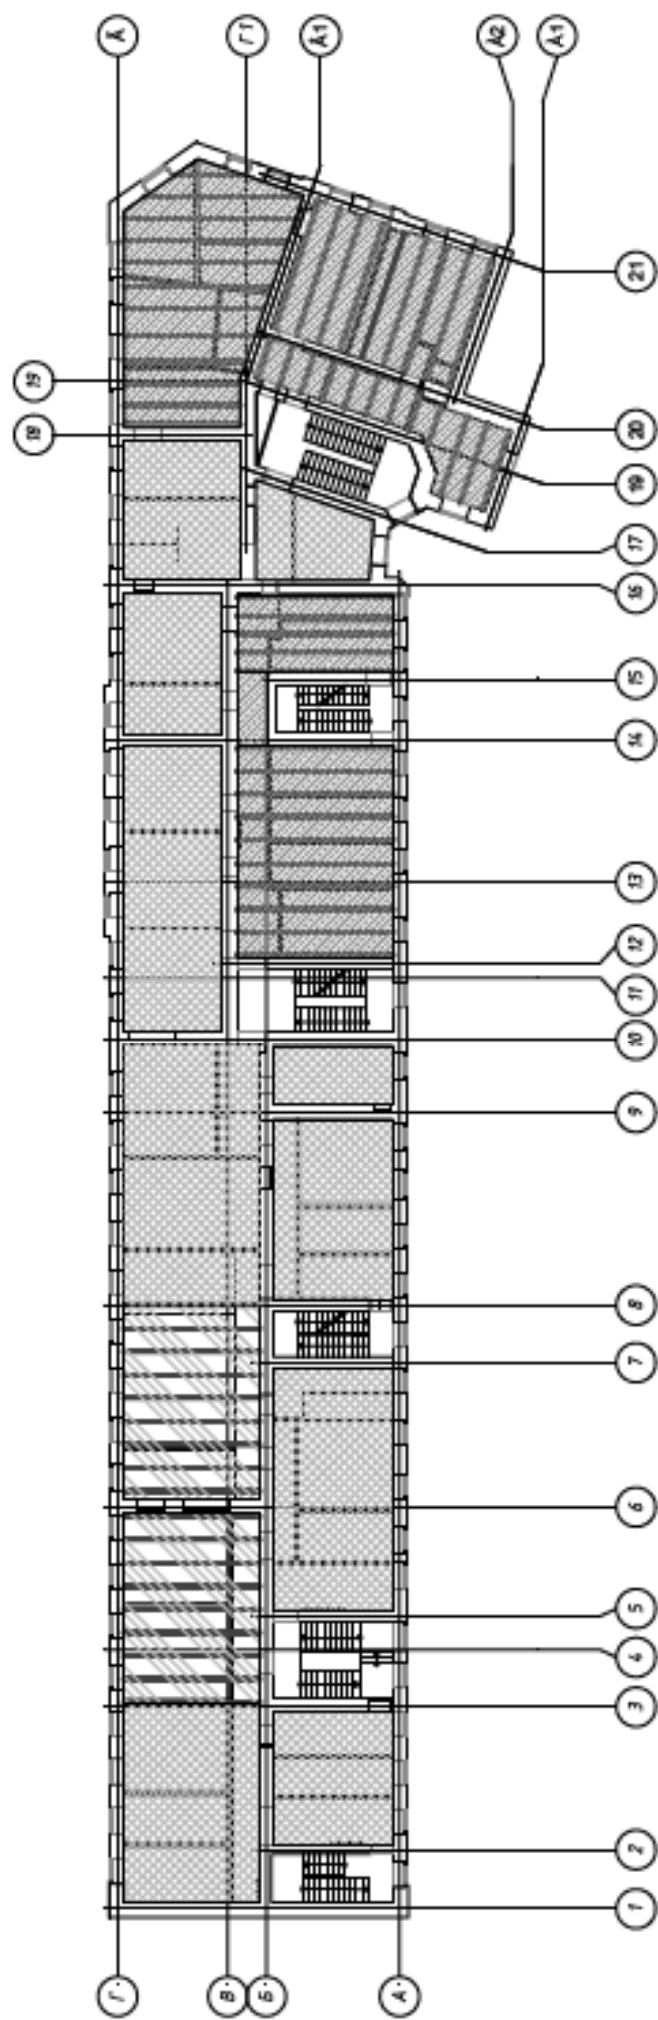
Схема расположения балок 2-го этажа (шаг балок 1000-1250мм)
